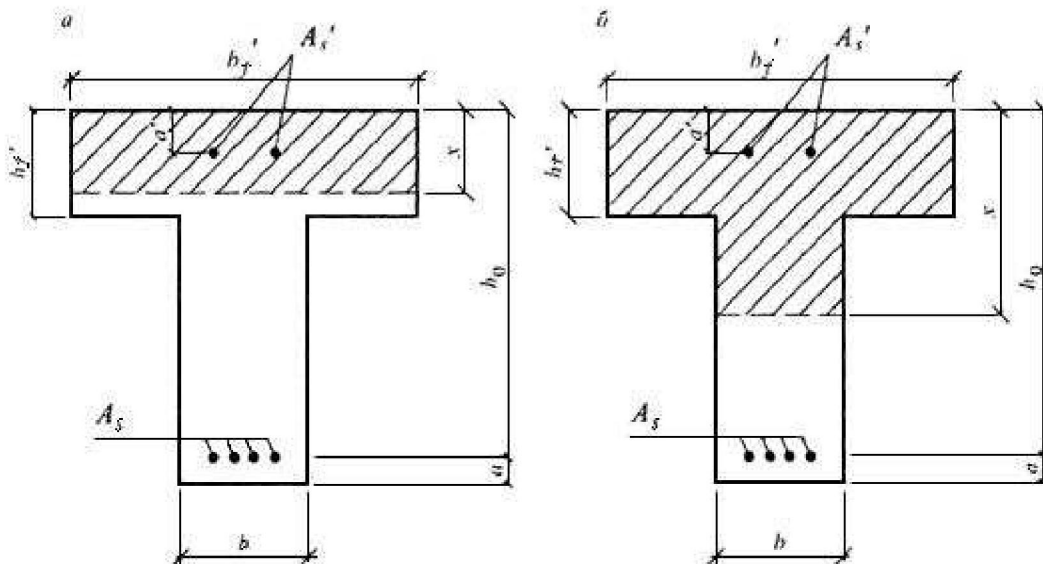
Положение границы сжатой зоны в сечении изгибаемого железобетонного элемента [11]
